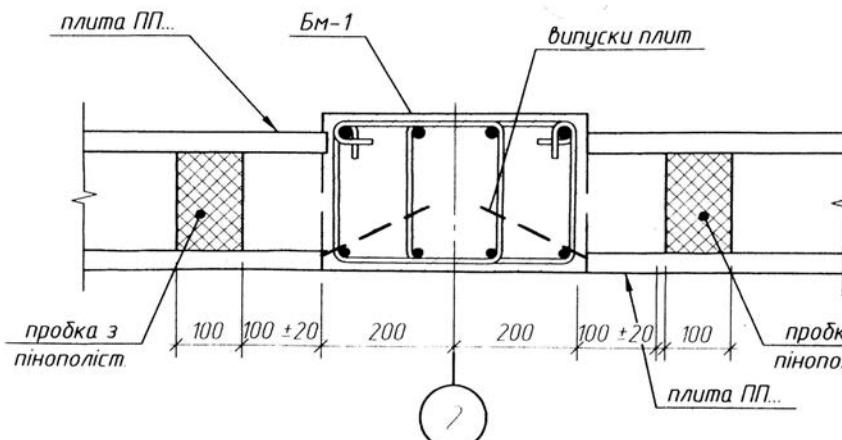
Схема об'єднання плит з балкою стикуванням арматури балок і випусків змонтованих плит та бетонуванням балок разом з пустотами плит до обмежувачів за числовими осями.
